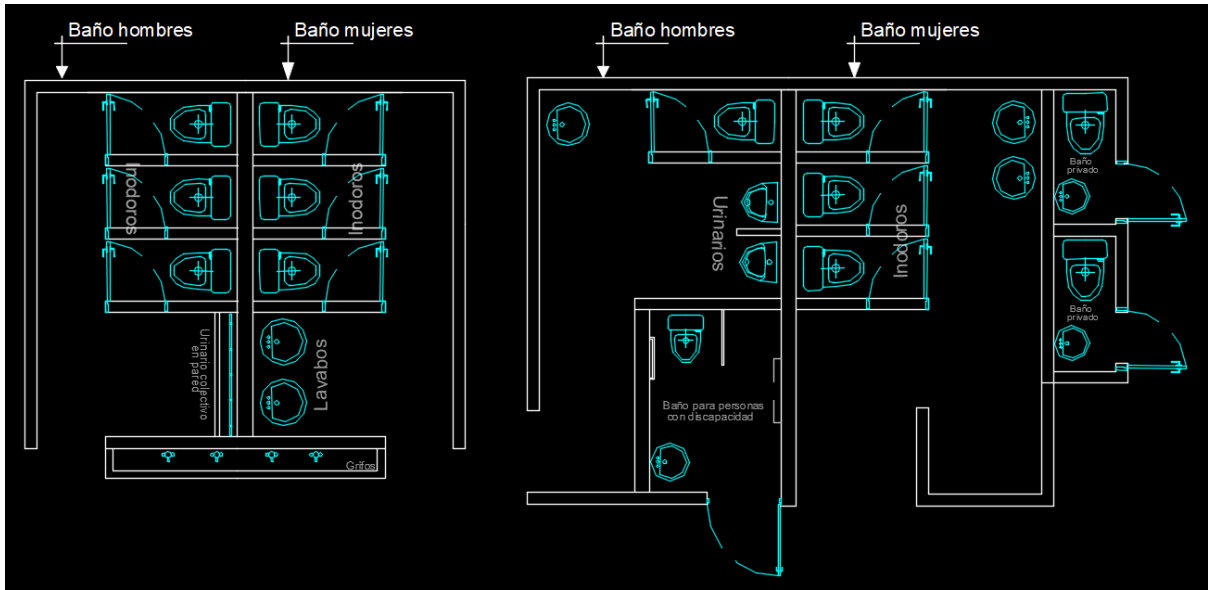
Plano arquitectónico actual de la batería frente a los juegos del bloque 2. Fuente: autoría propia
